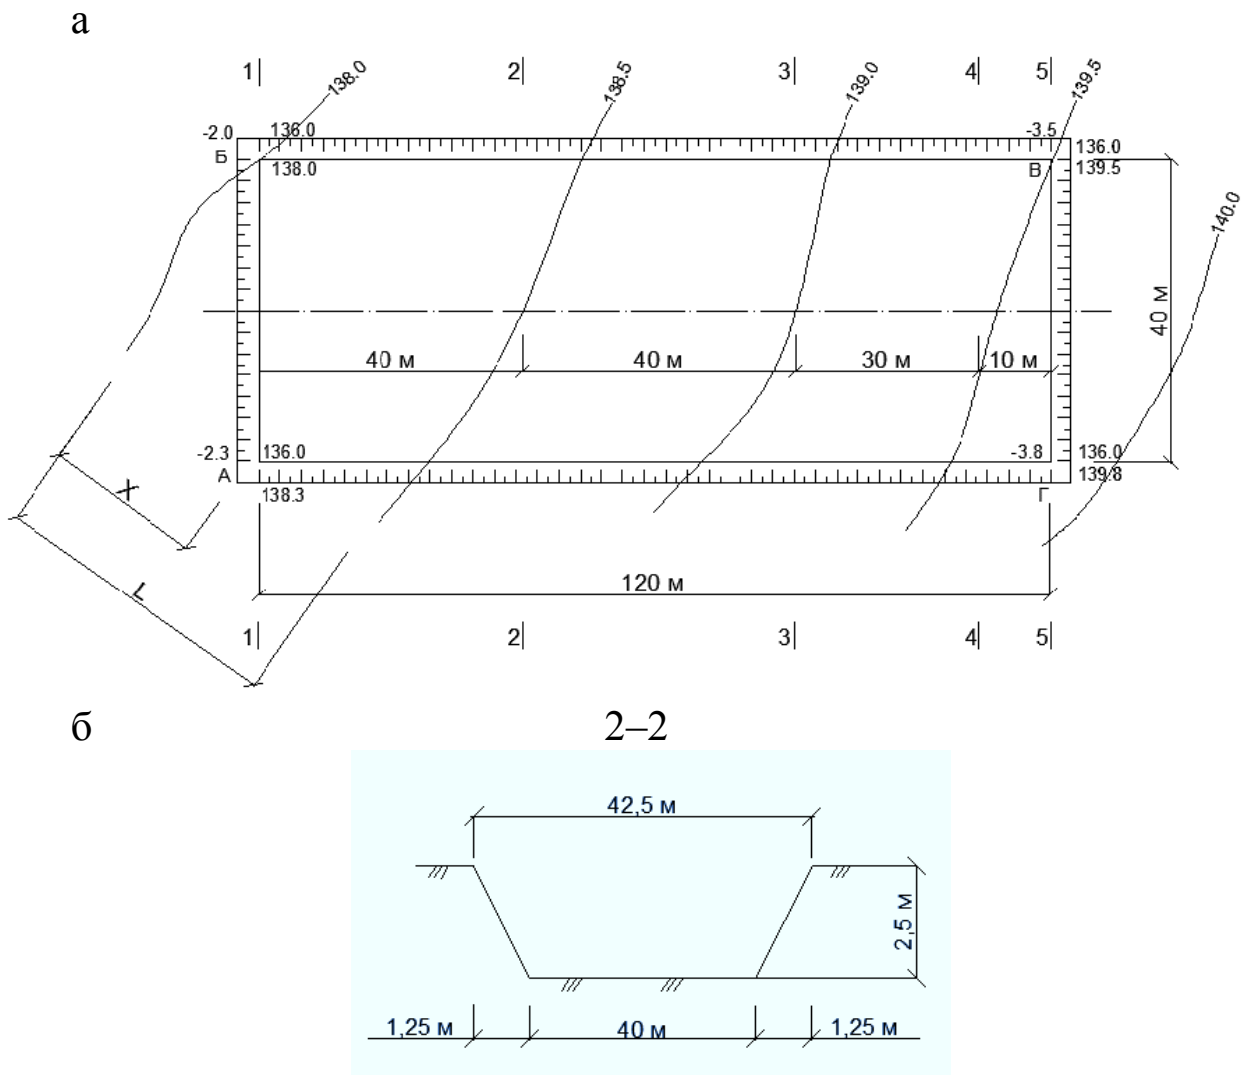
План площадки: а – план котлована; б – сечение 2–2
